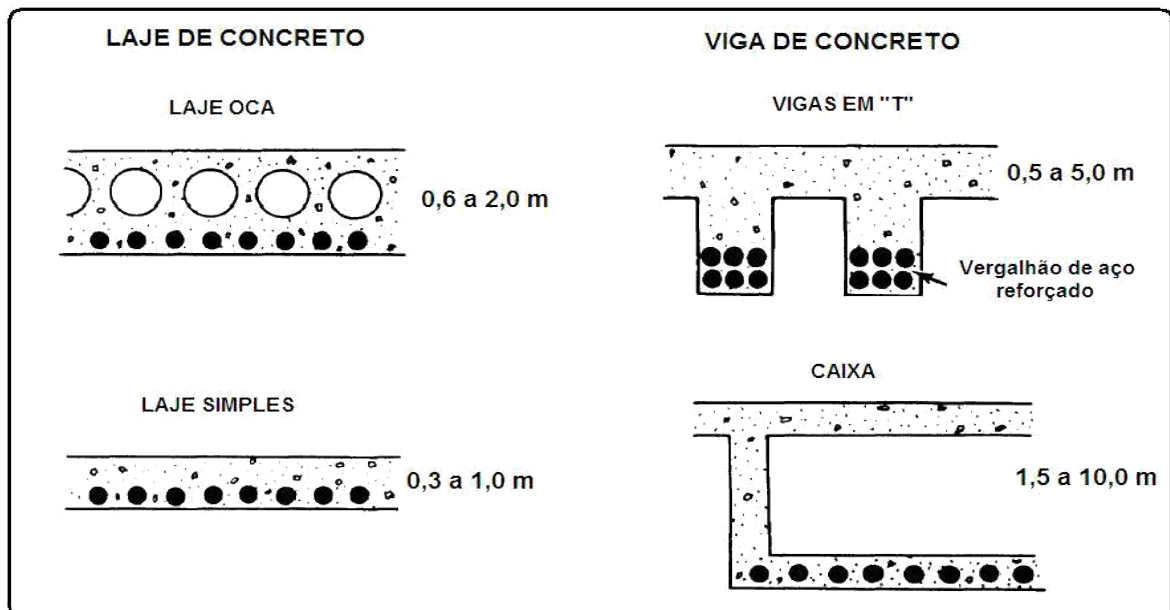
Corte da parte central do vão de pontes de laje e vigas de concreto
